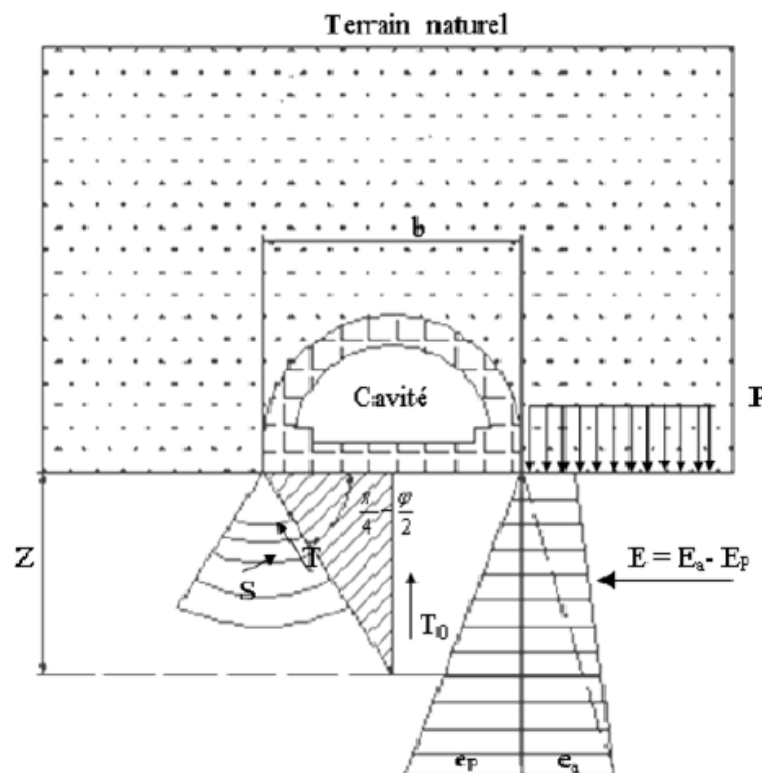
calcul de la poussée au radier d'après Tsimbarievitch
